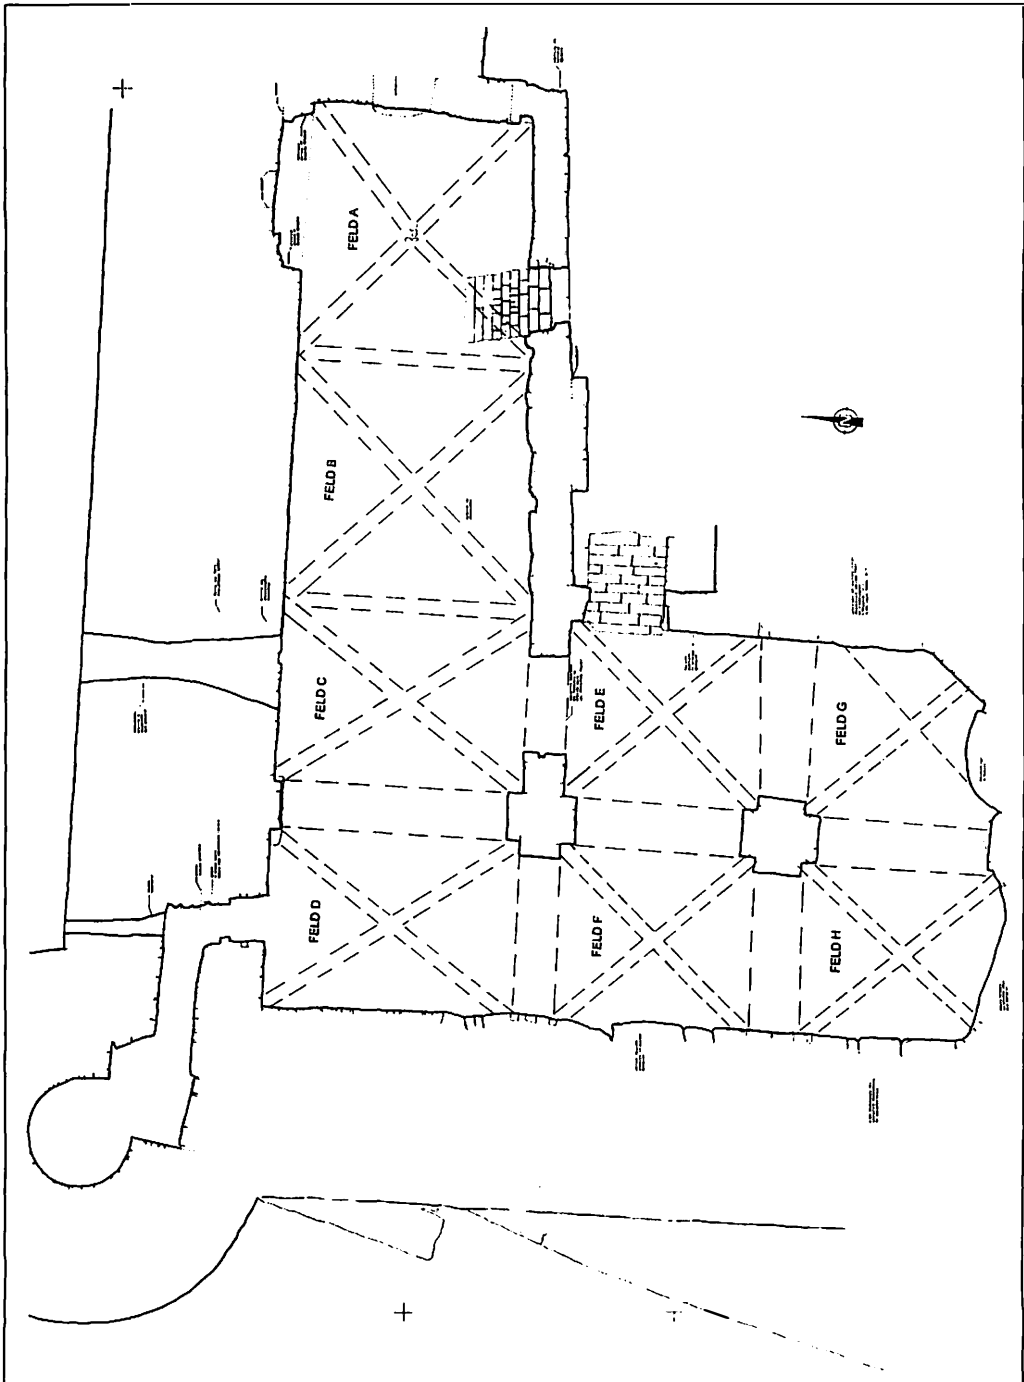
Kellergewölbe der Hardenburg. Grundriß
